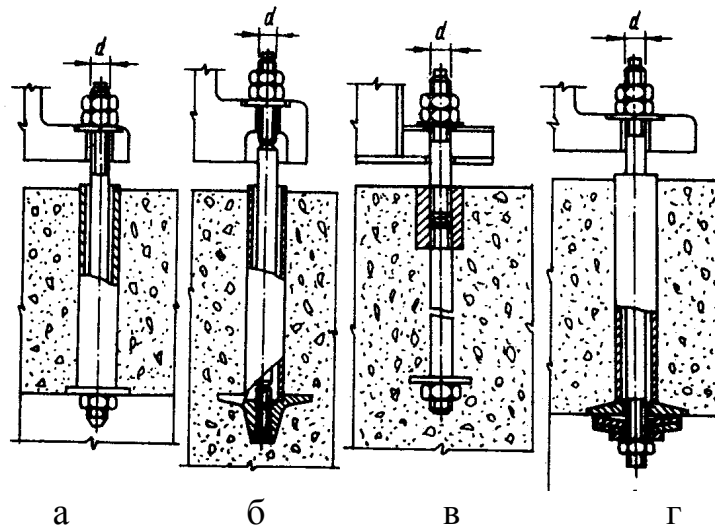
Анкерні болти, встановлювані до бетонування фундаментів:
